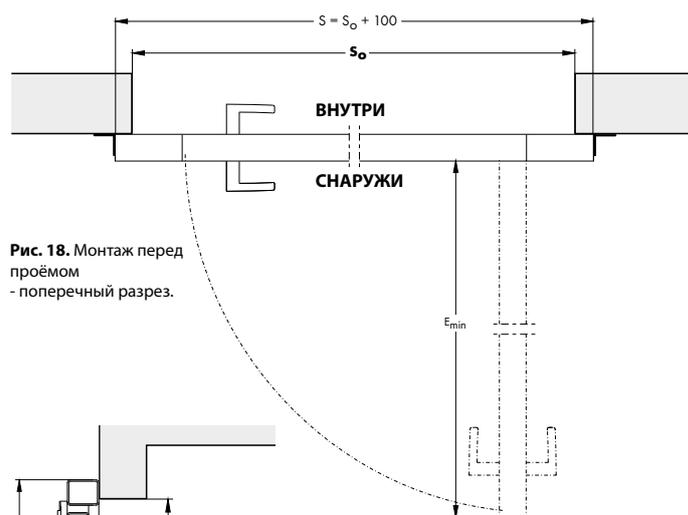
Монтаж перед проёмом - поперечный разрез.
